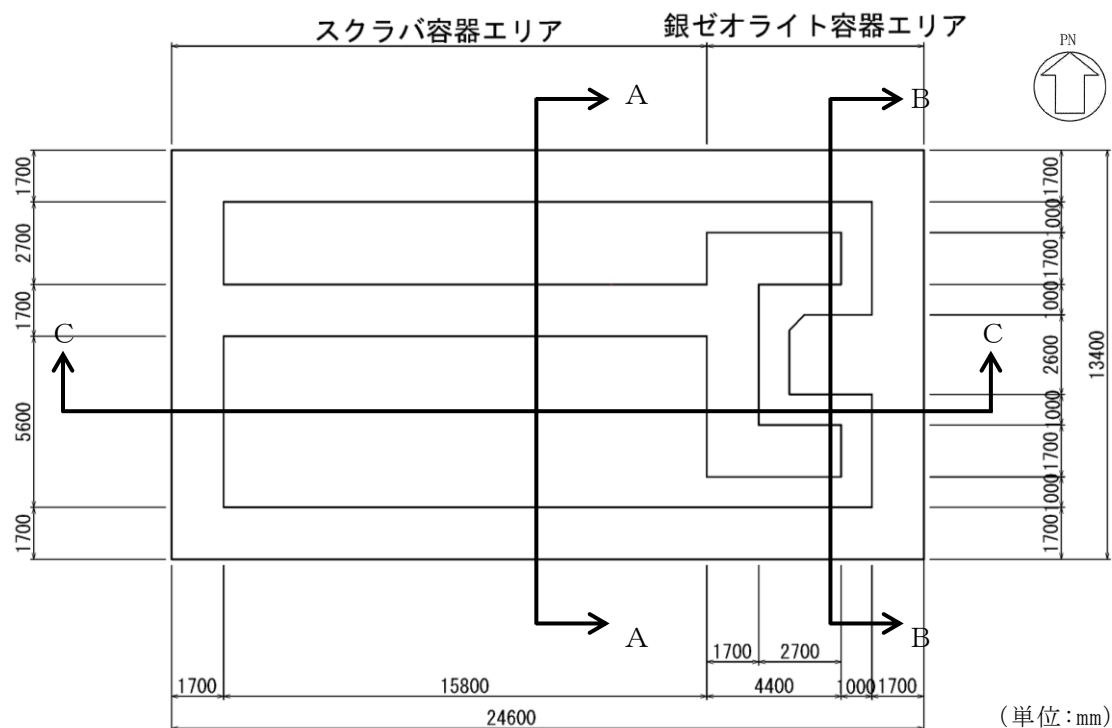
第1ベントフィルタ格納槽 平面図 (EL 3.00m)
